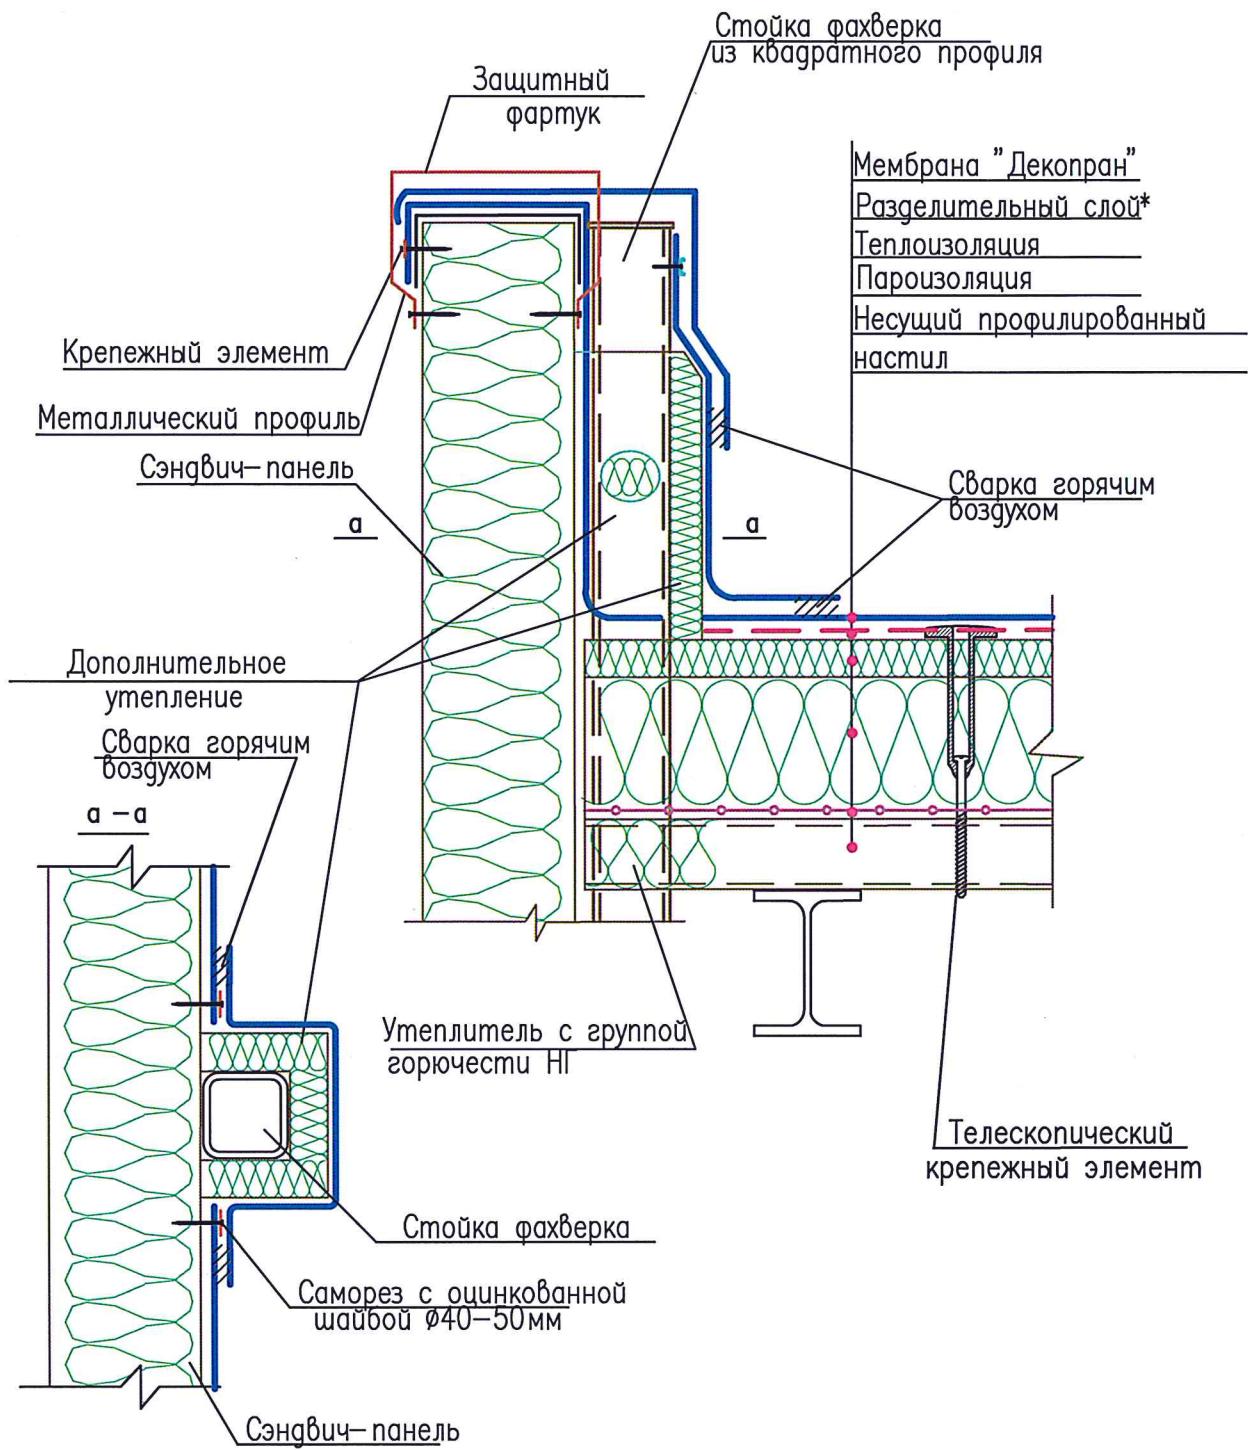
Конструктивные решения узлов для кровли с несущим профилированным настилом с механическим закреплением. Устройство узла примыкания мембранны к стойке фахверка
